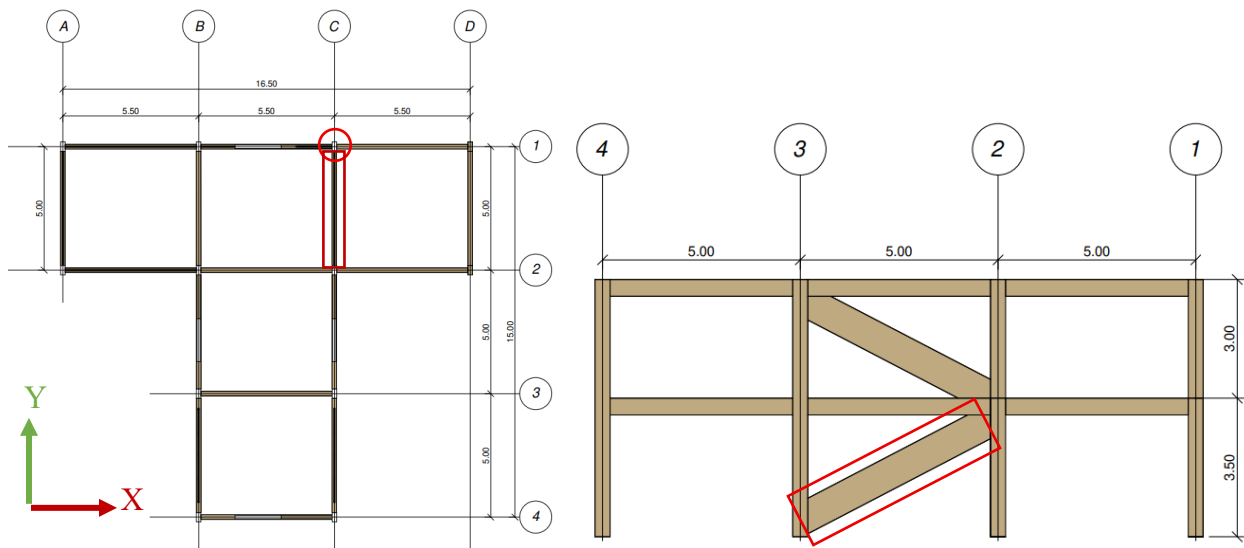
Planta y sección caso de estudio. Fuente: elaboración propia
